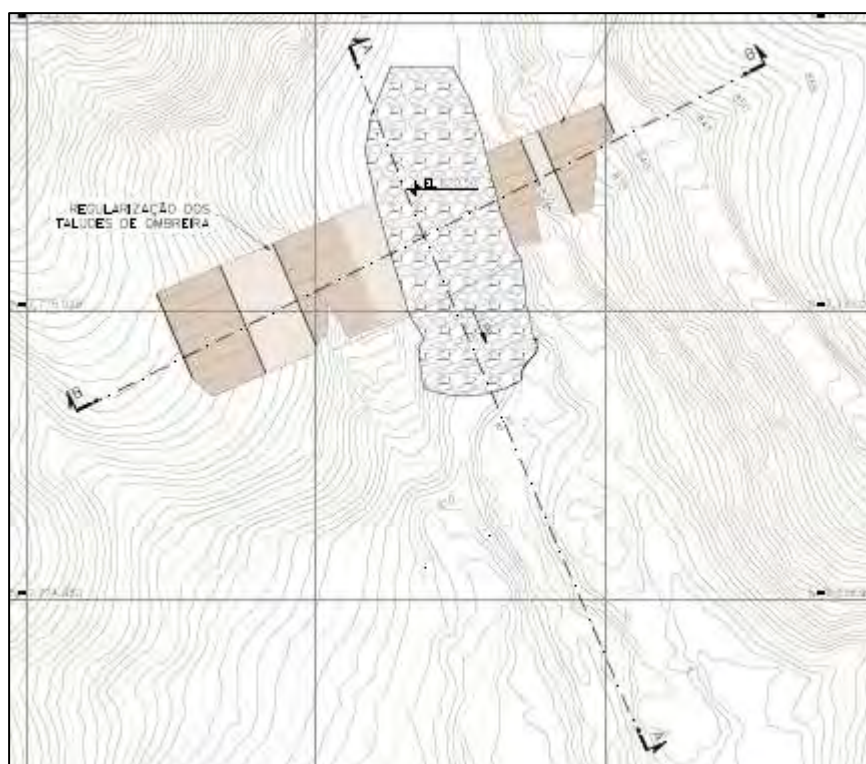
Planta de locação da Seção A-A e B-B para análises de estabilidade.
